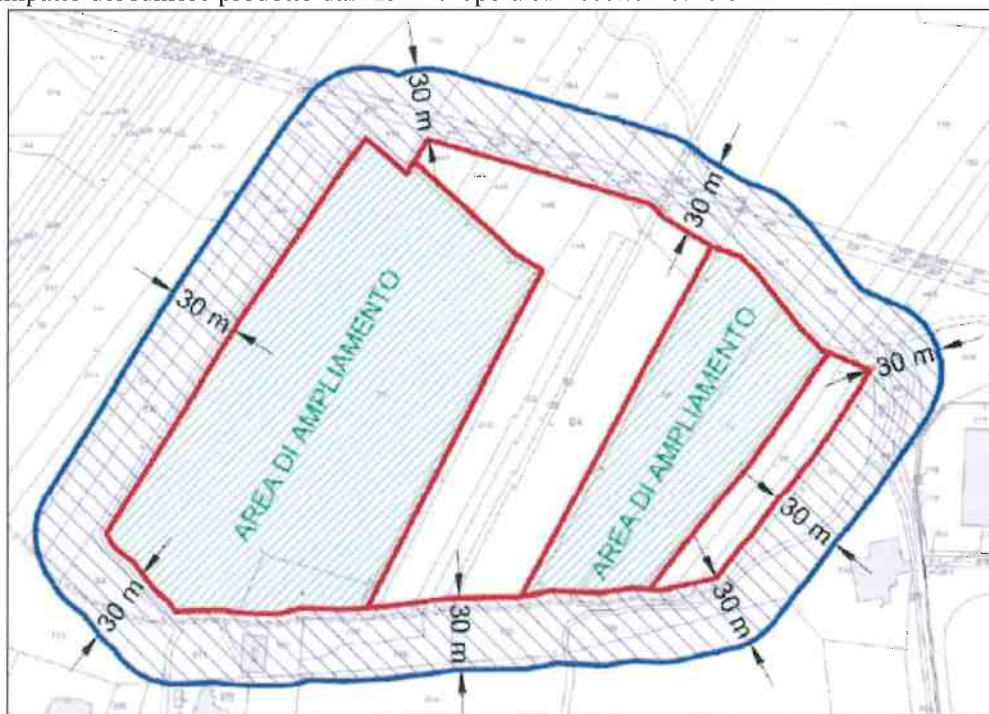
Fascia di rispetto di 30 m (dallo SPA)
